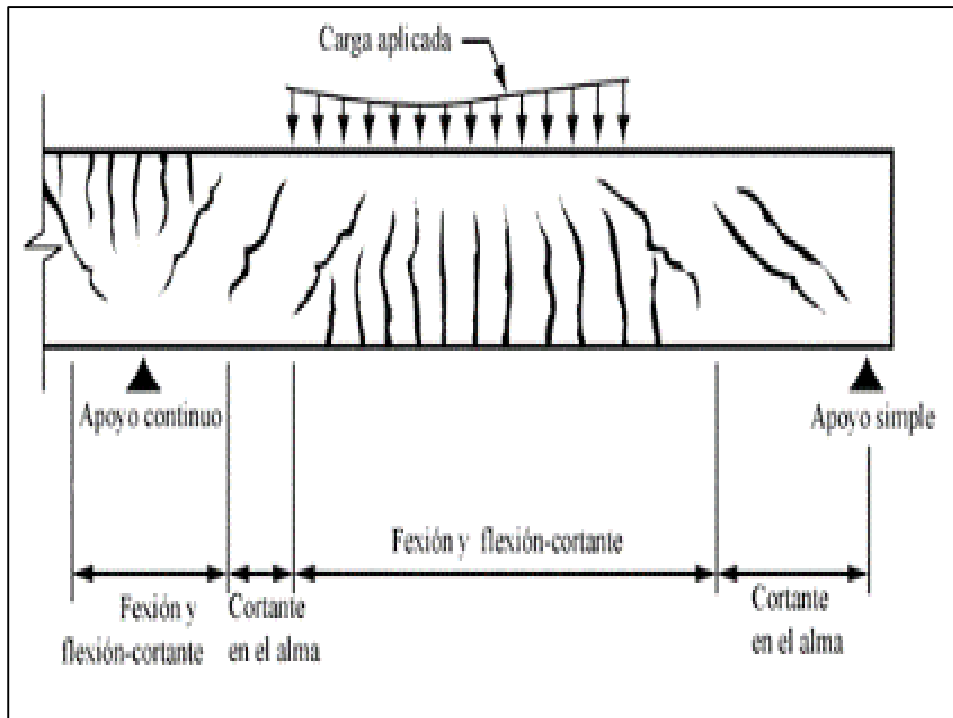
Tipos de Agrietamiento en Vigas de Concreto.
